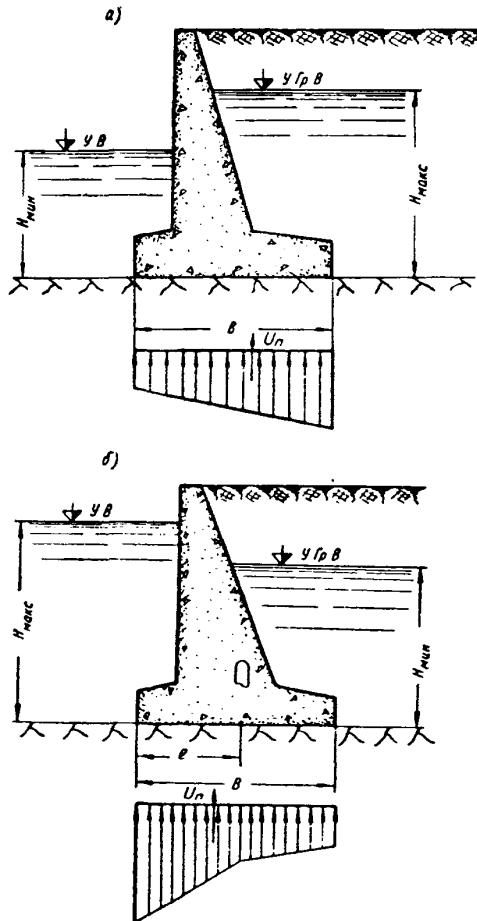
Эпюры противодавления при скальных основаниях подпорных стен
